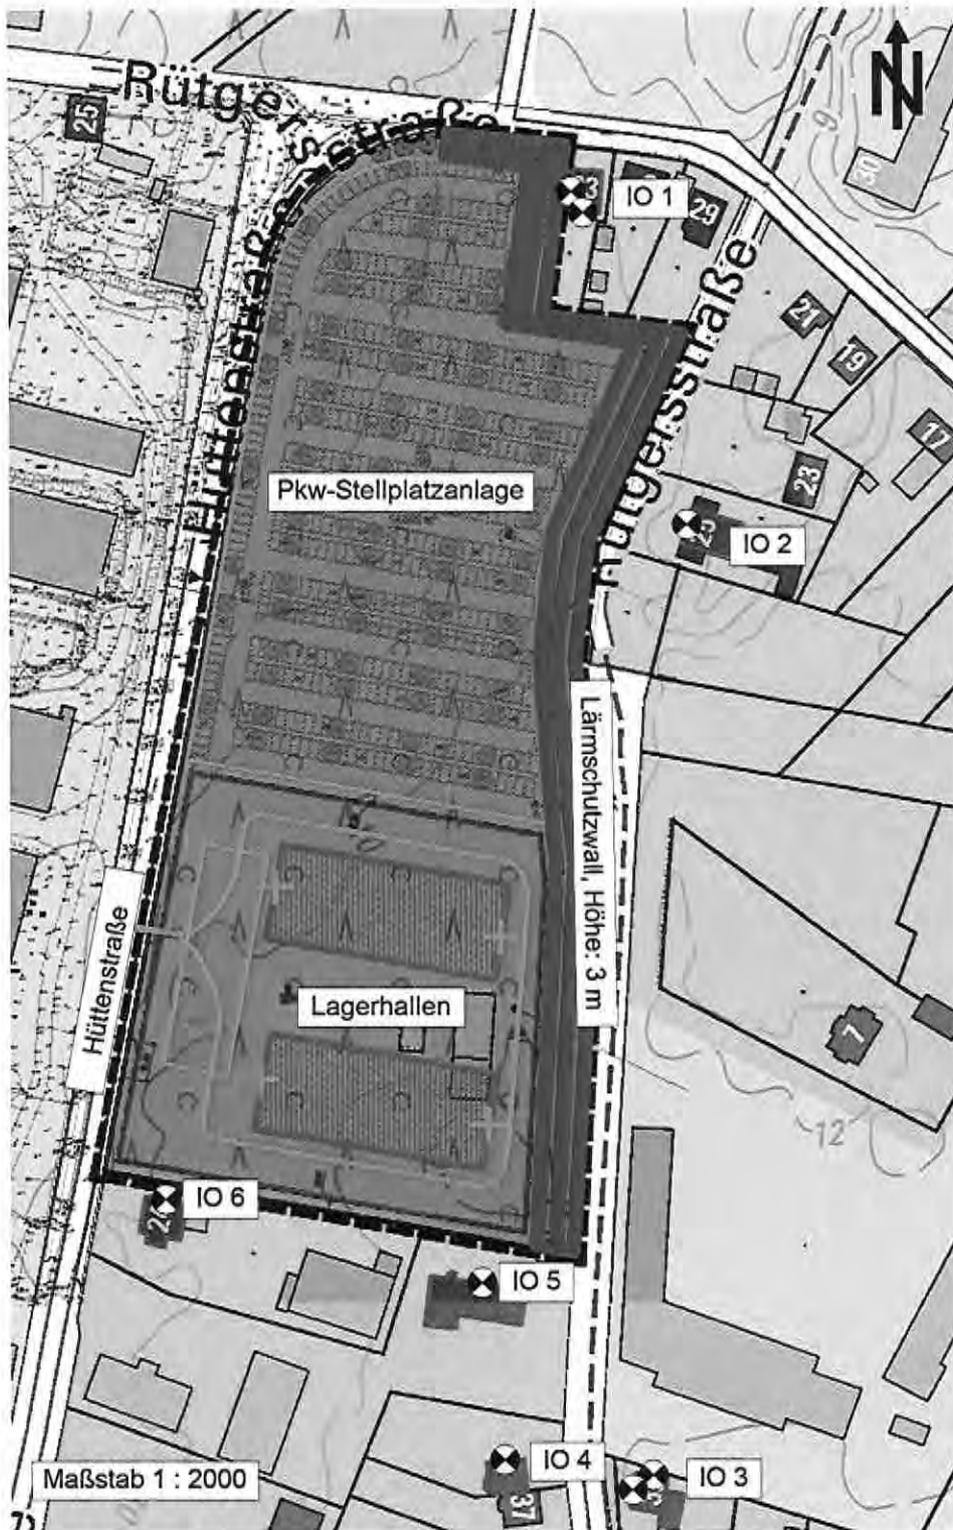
Lageplan Plangebiet mit Emissionsmodell der geplanten Anlagen und Immissionsorten.
